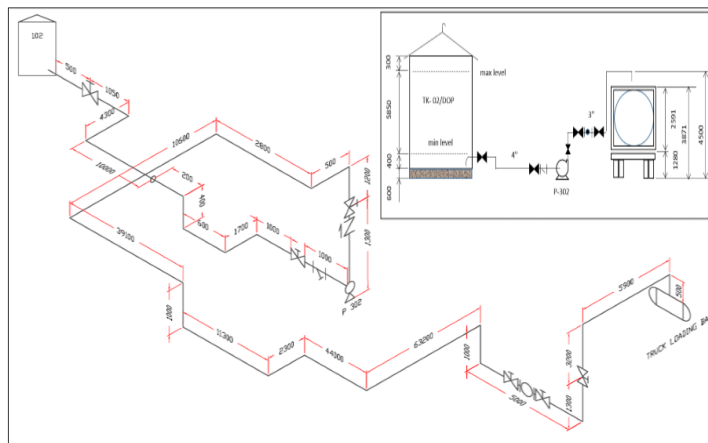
Jalur Pipa Pandangan Atas (*Plan View*)^[1]
